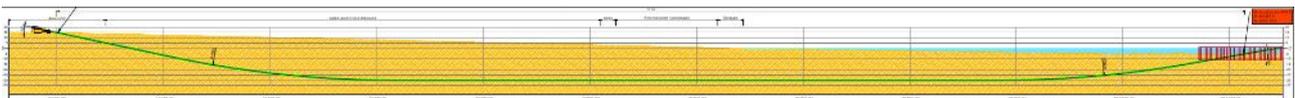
Profilo longitudinale percorso HDD terra-mare (Horizontal directional Drilling)
